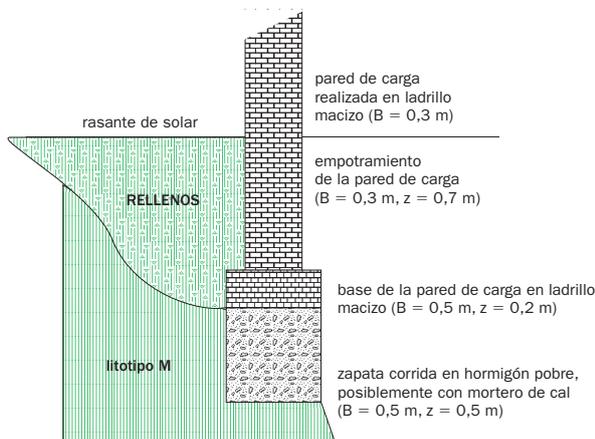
Secció de fonaments de façana. | Sección de cimientos de fachada.
